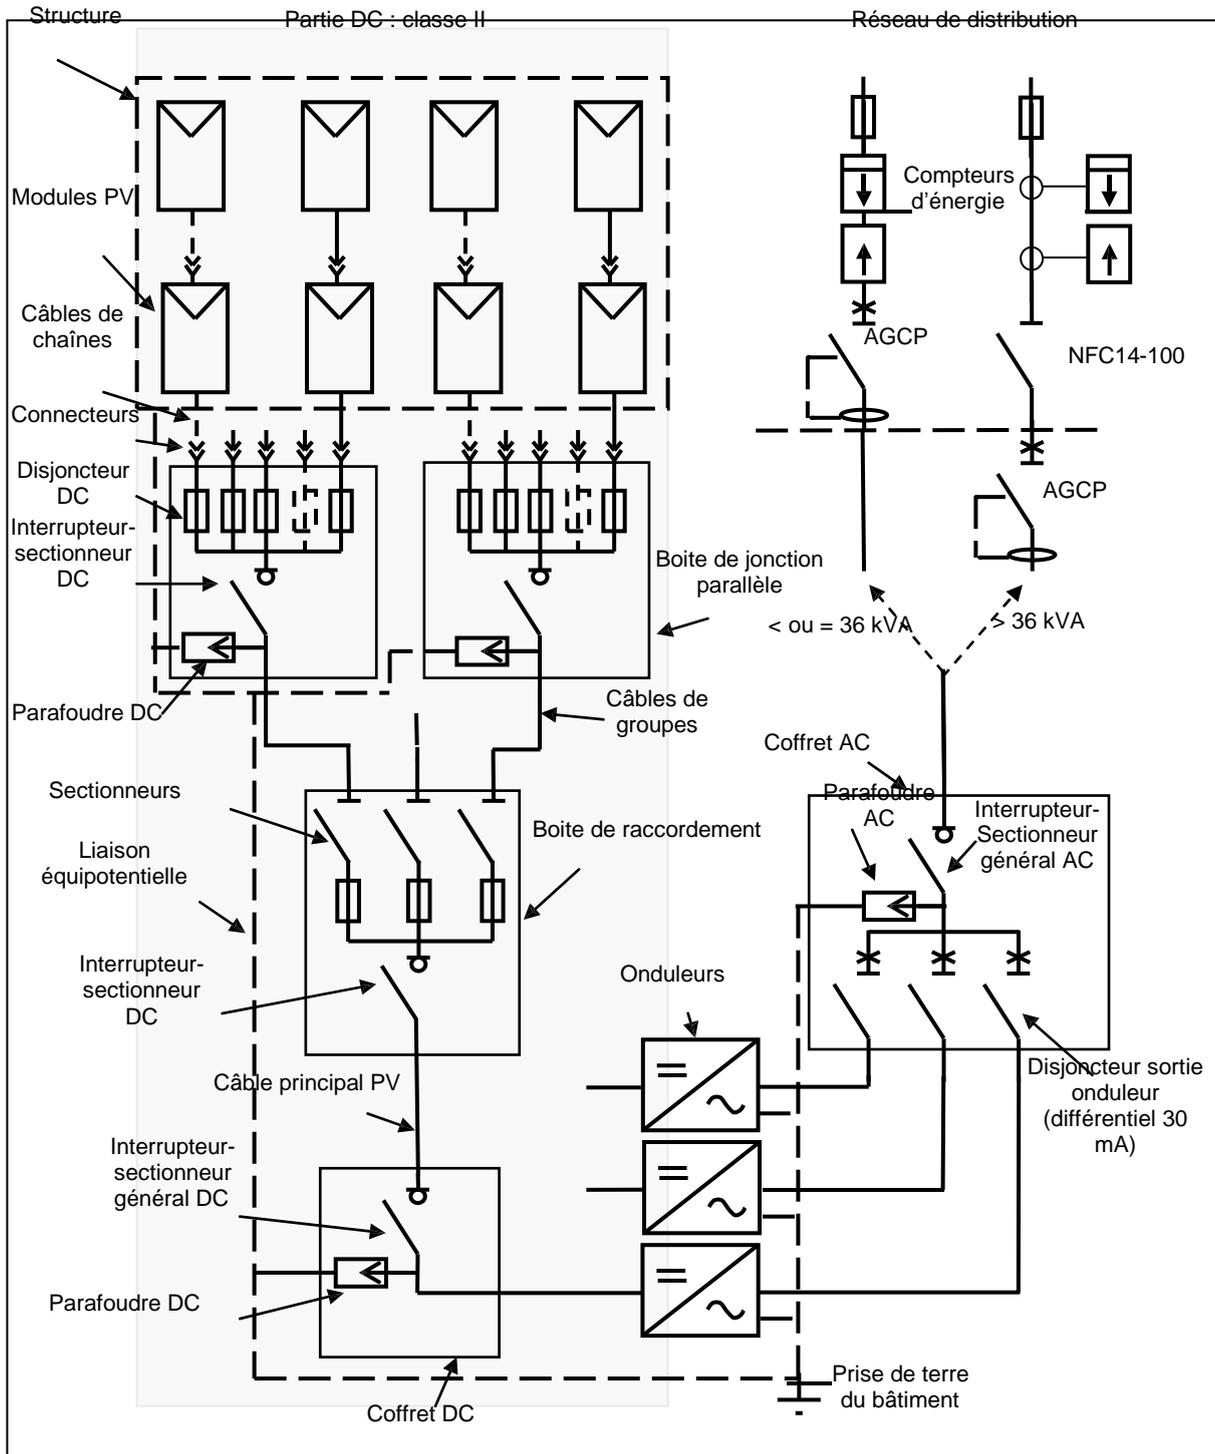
Schéma unifilaire type d'une installation PV raccordée au réseau BT
